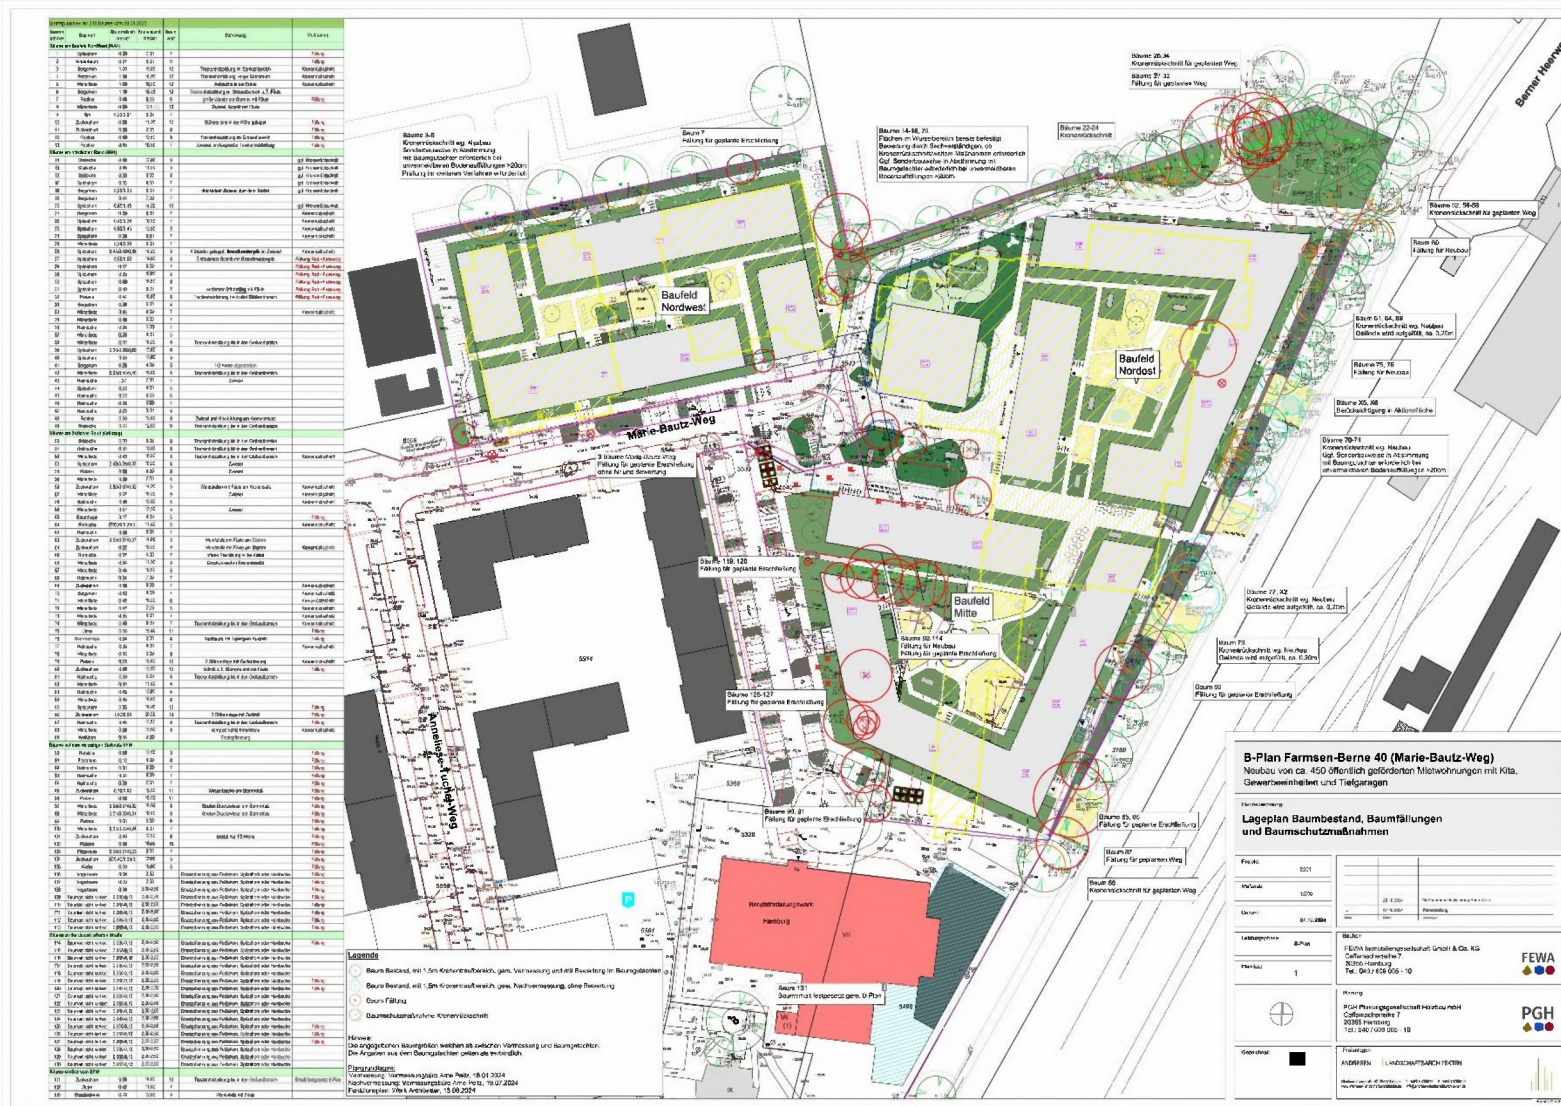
Lageplan zum Baumgutachten, Teilbereich WA1 (Verkleinerung)
